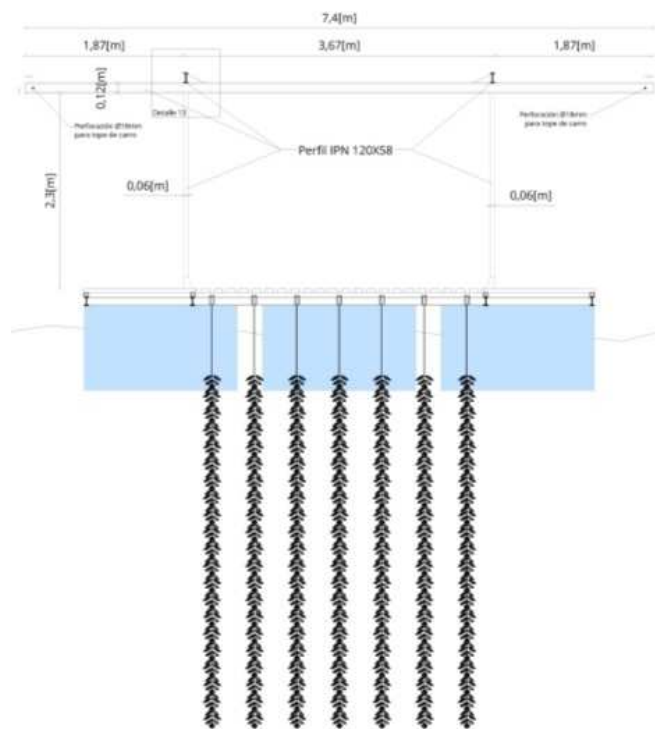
Estructura de acero. FUENTE: Elaboración propia.
